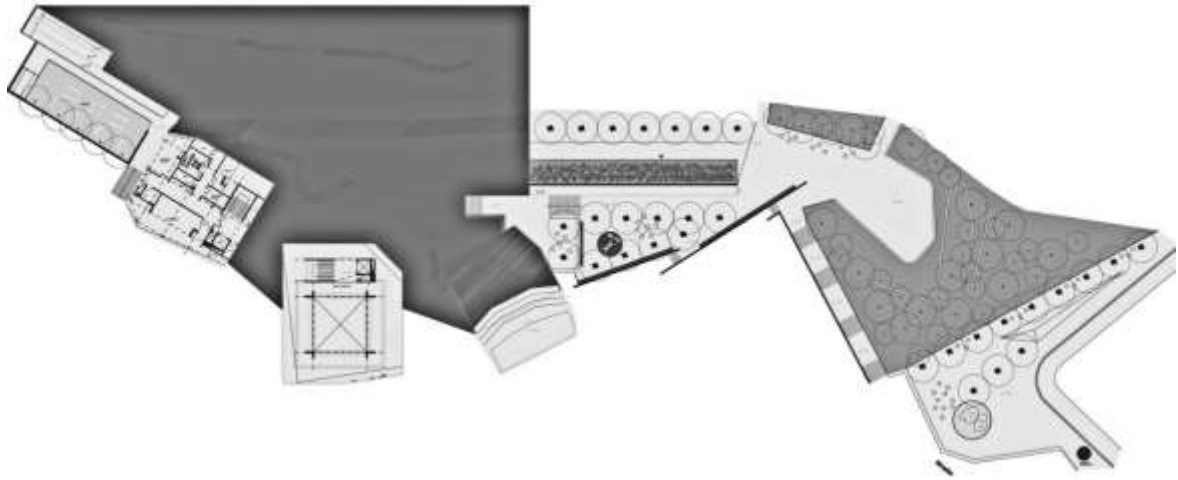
1RA PLANTA DEL PARQUE BIBLIOTECA ESPAÑA
